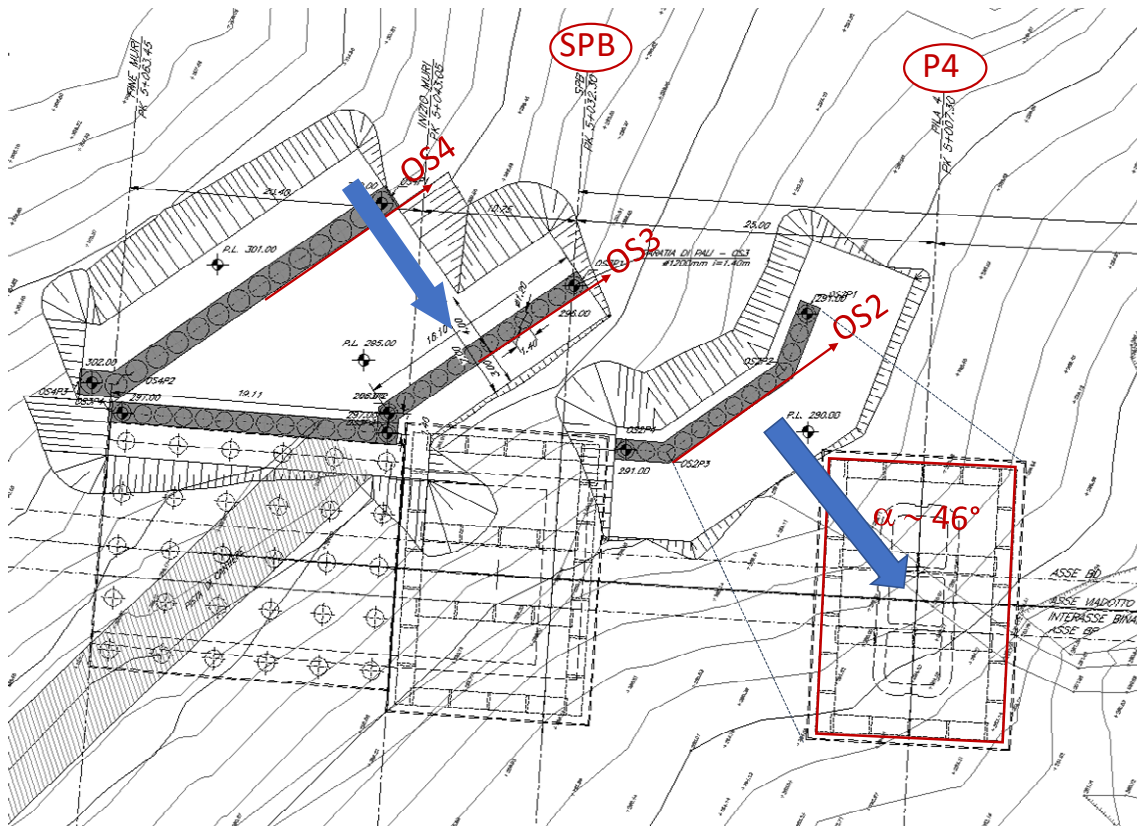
Viadotto VI02. Pila 4 e Spalla B: inquadramento opere di sostegno e stabilizzazione OS2-OS4
